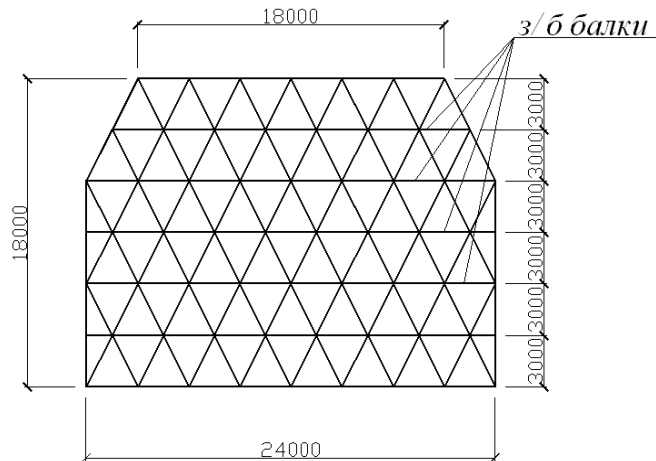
До розрахунку збірного залізобетонного кесонного перекриття
